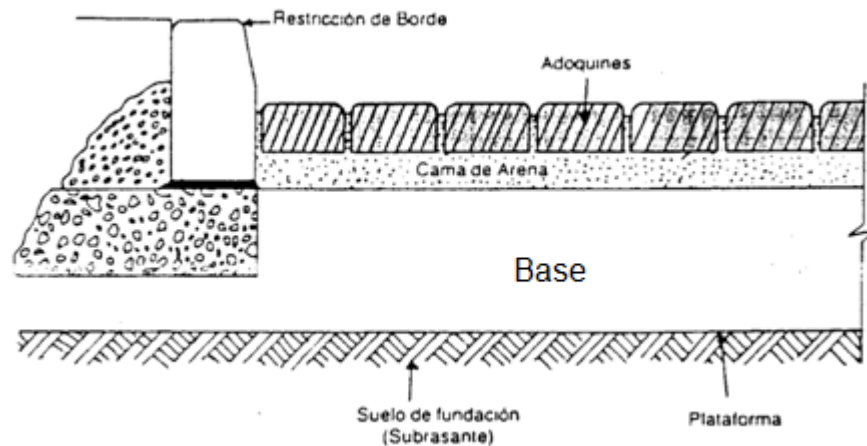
Estructura típica de un pavimento de adoquines trabado. [4]
